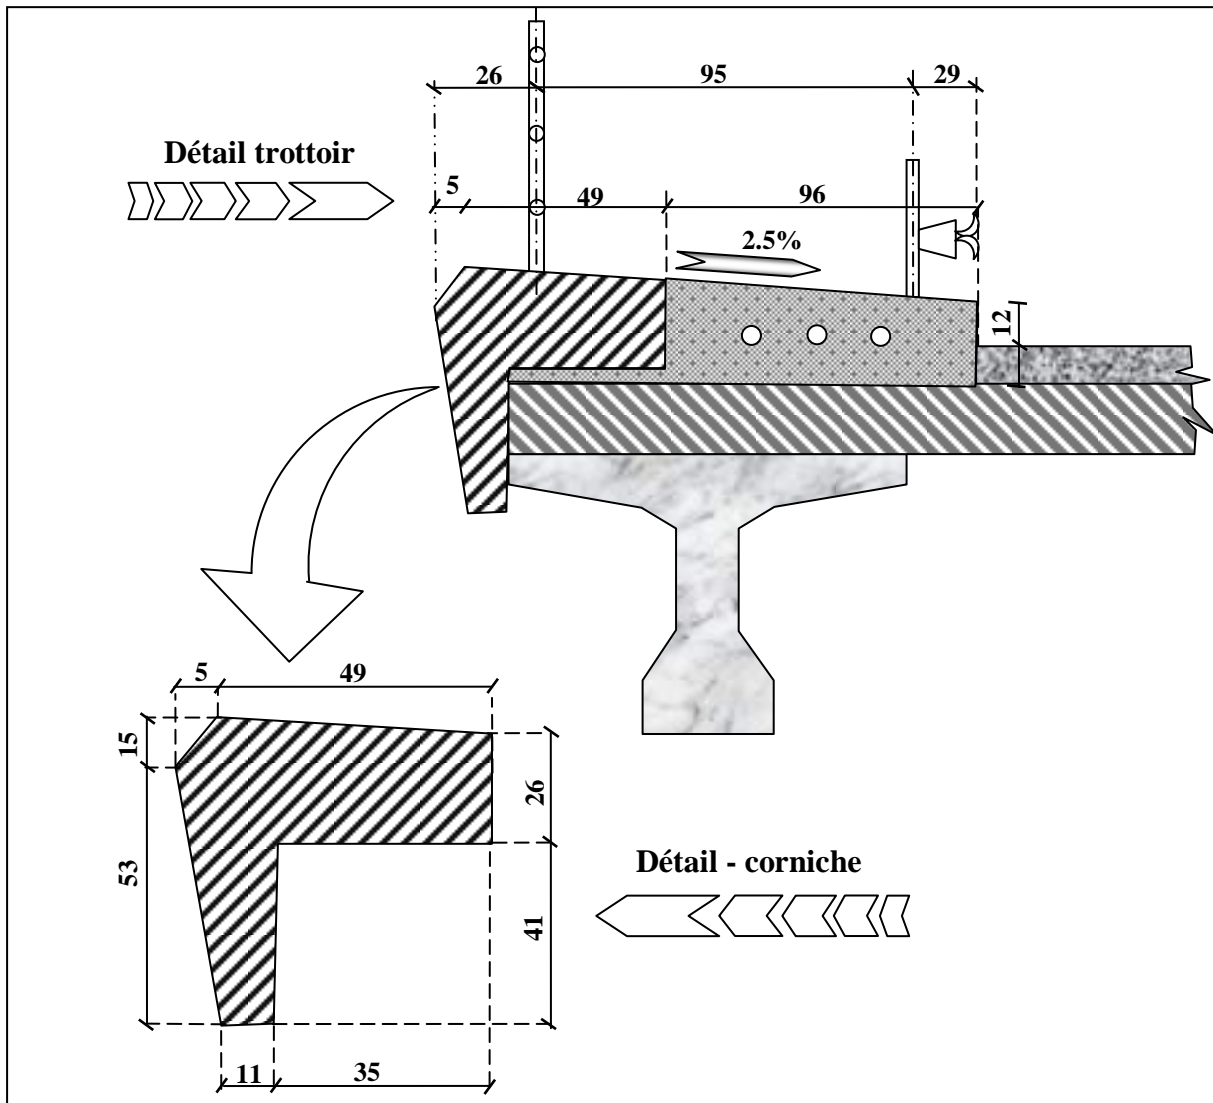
Détail du trottoir et de la corniche sur la poutre de rive
